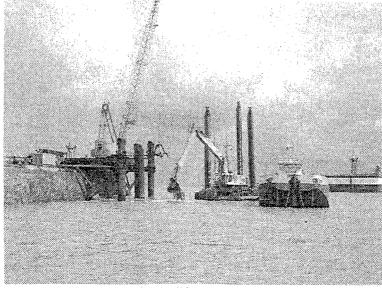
Vue générale de l'installation du chantier EMCC (grue sur plate-forme).
